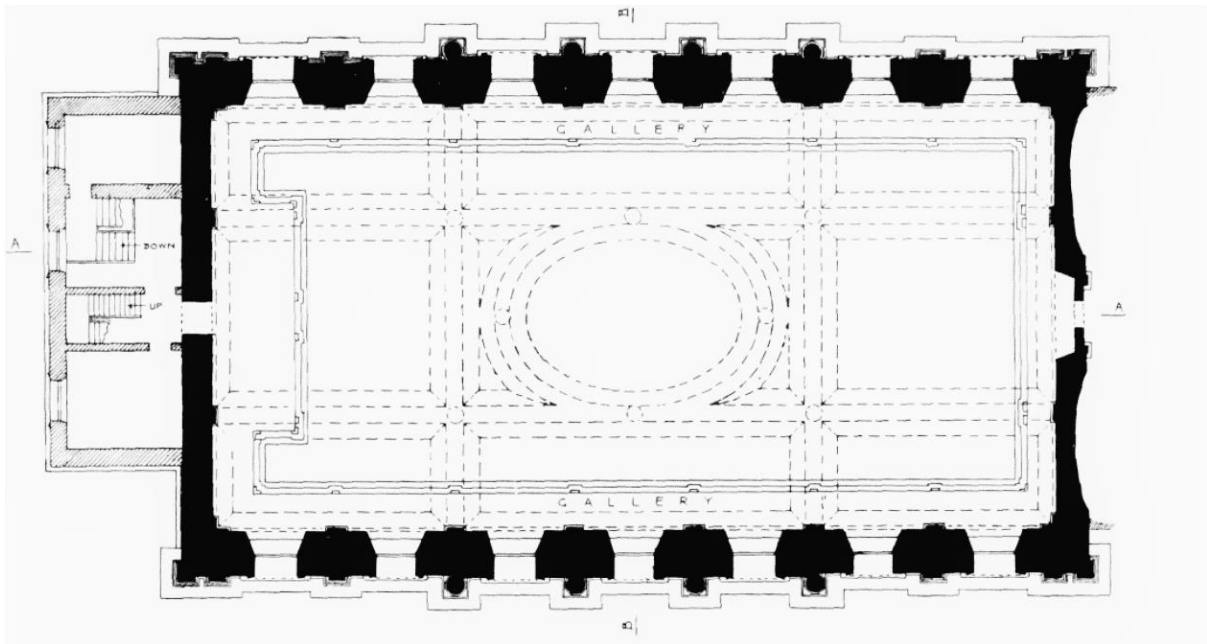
Inigo Jones: *Banqueting House*, Grundriss Hochparterre, Whitehall/London, 1619 – 1622
